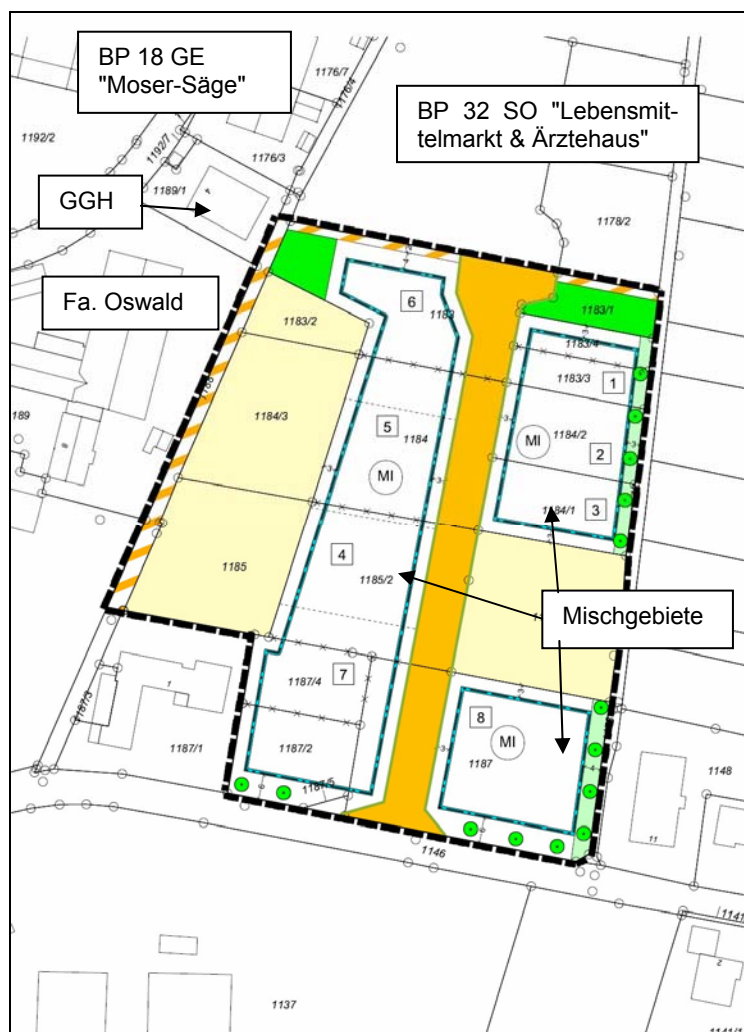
Bebauungsplan 33 "Mischgebiet Kranzer Nord", Lageplan
